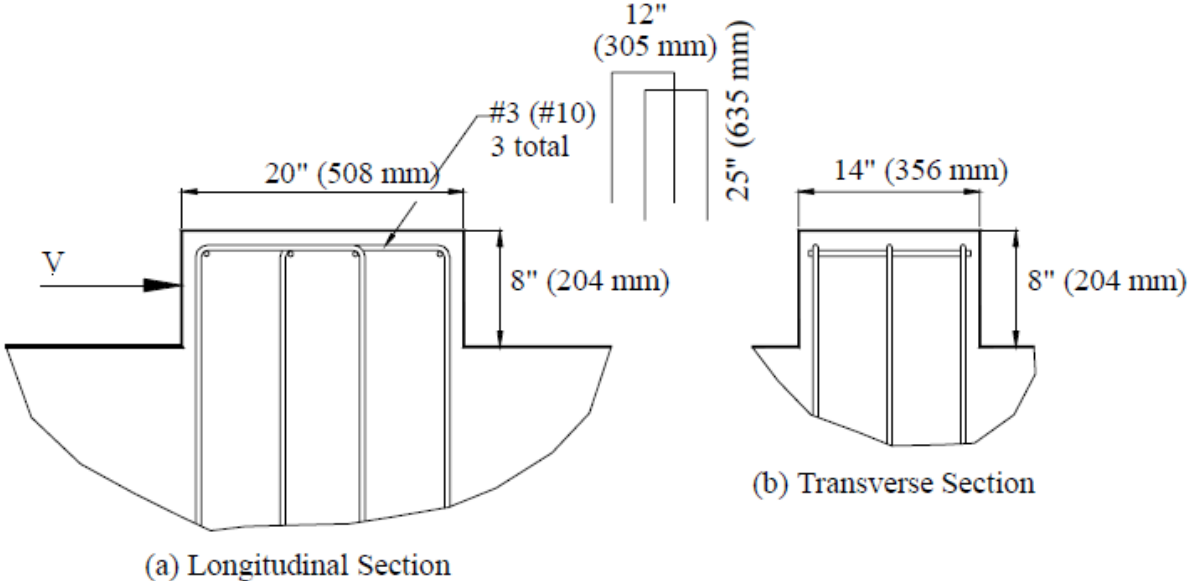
Vista en Elevación de Refuerzos – Serie 1,2 Interna (Megally et al., 2002).
